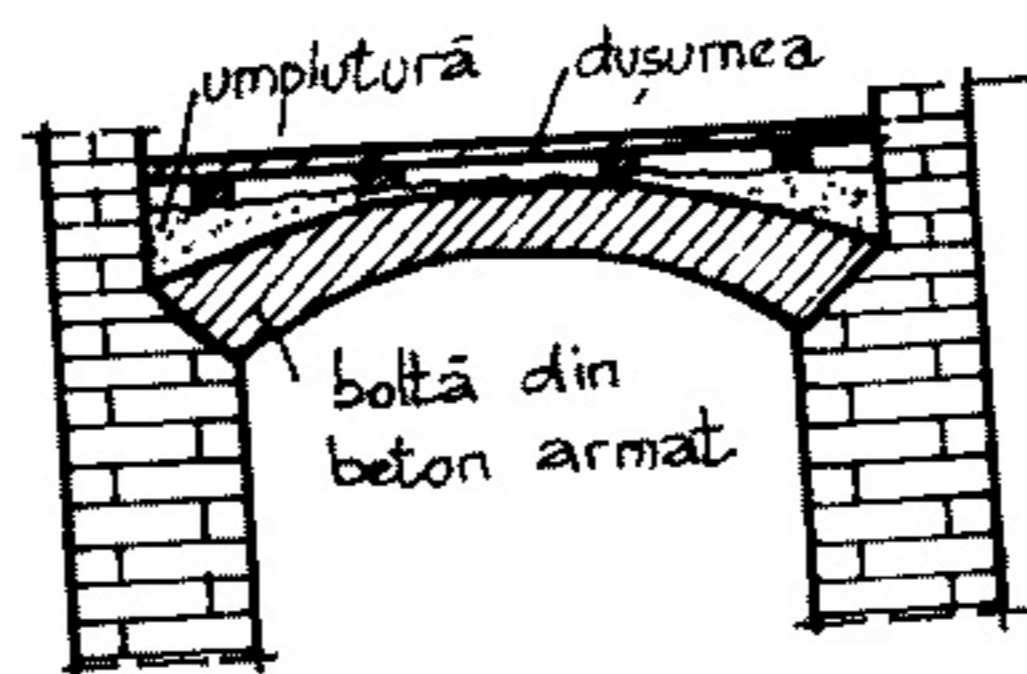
Boltă din beton armat monolit cu grosime variabilă
